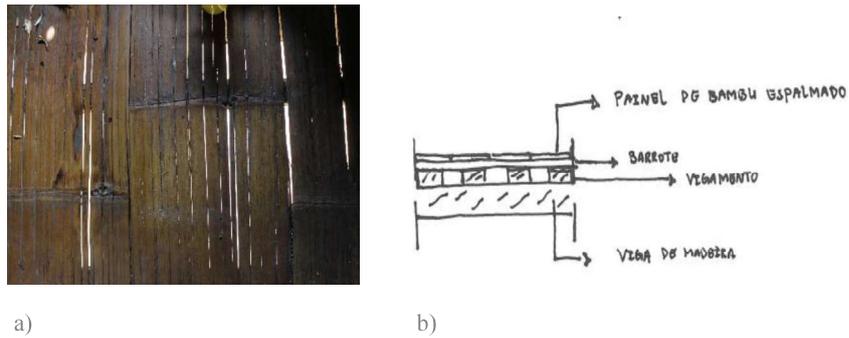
44. Pavimentos. a) Pavimento de bambu espalmado b) Desenho em corte do pavimento
